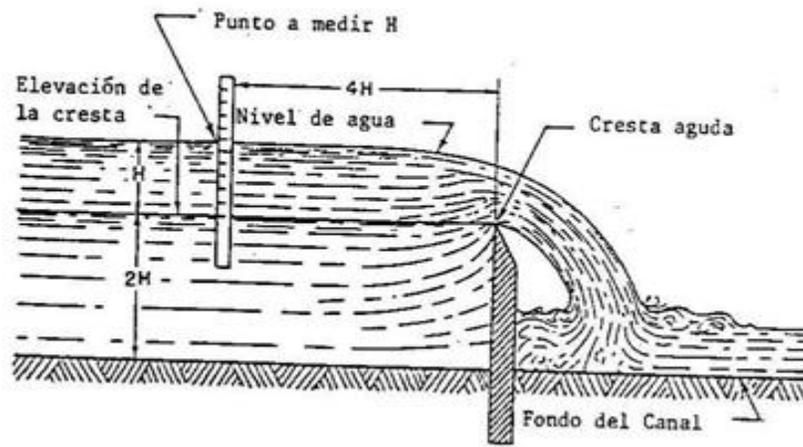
Instalación de un vertedero rectangular con contracción.
